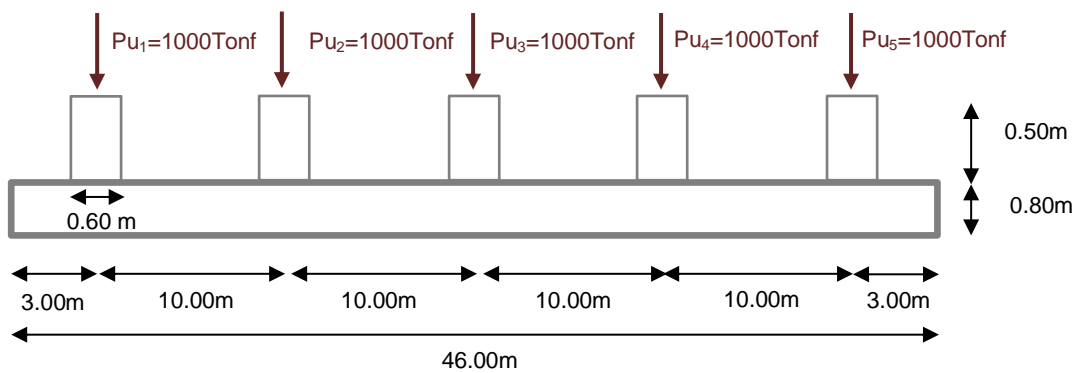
Zapata corrida con volados en los extremos de la losa (Elaboración propia).
